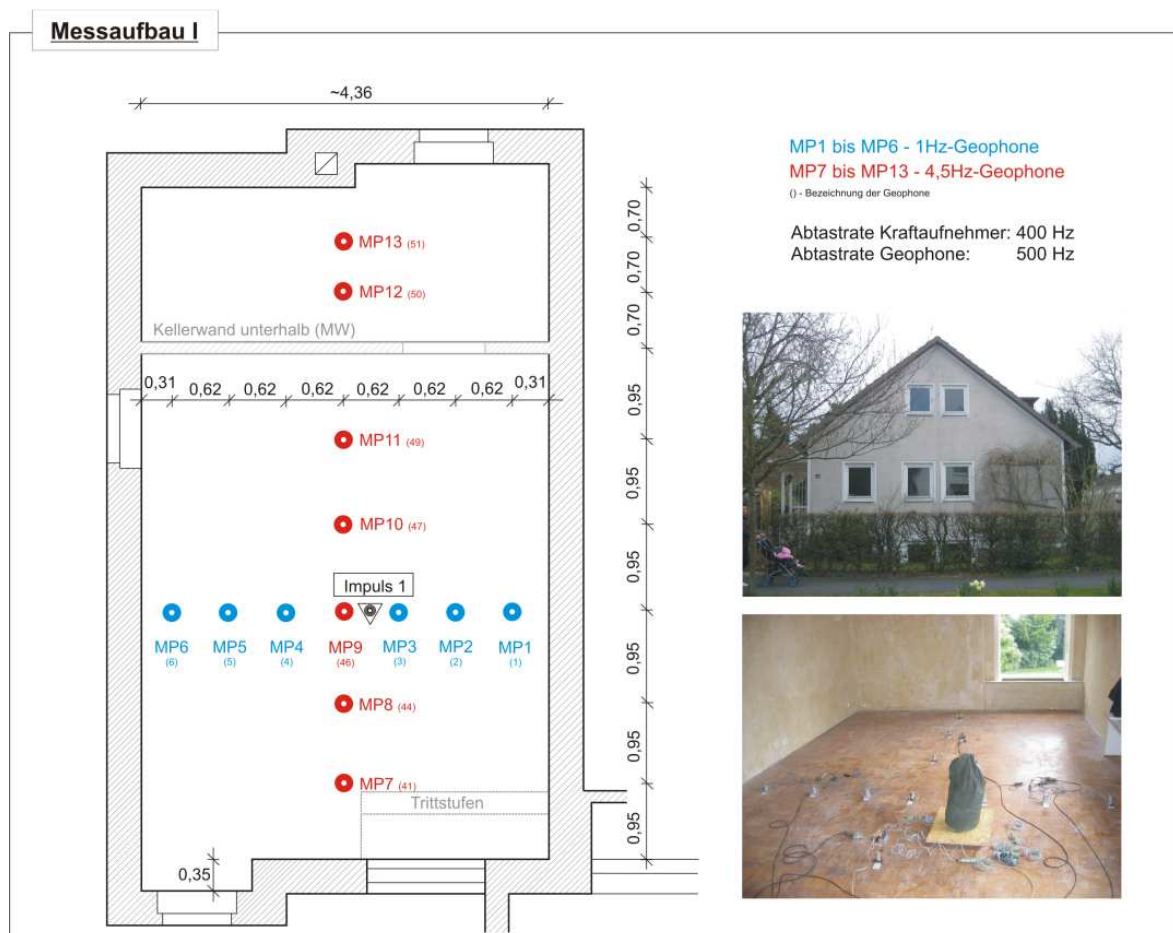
Messaufbau – Messung einer Stahlbetondecke in einem Einfamilienhaus
